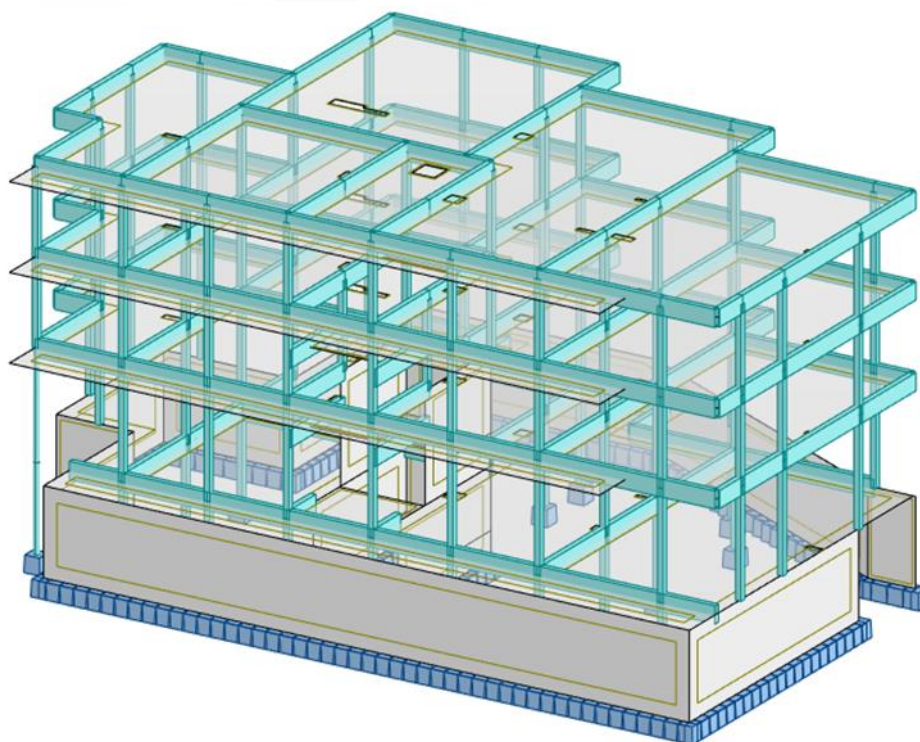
Modelação no *Robot* da estrutura com lajes apoiadas em vigas
